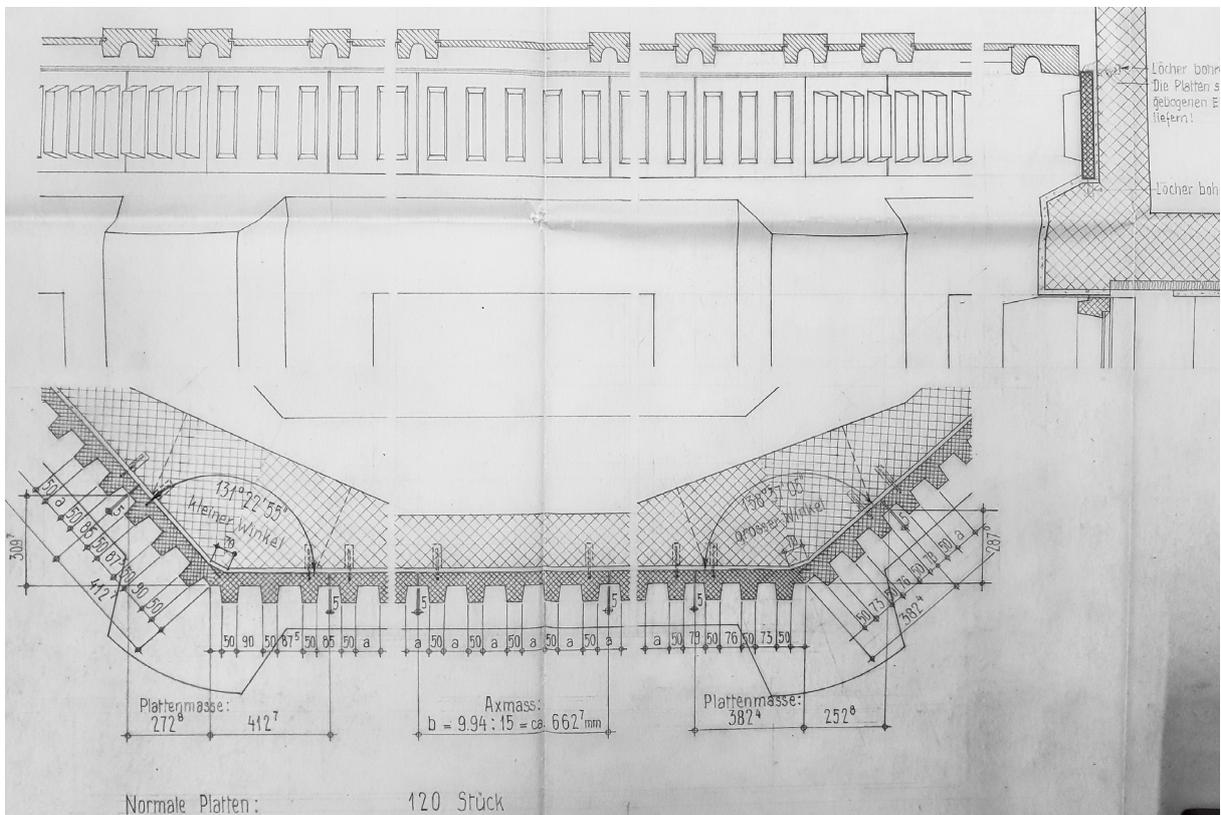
Detailgrundriss der vorgefertigten Betonzähne, insgesamt 120 Stück à ca. 60cm
